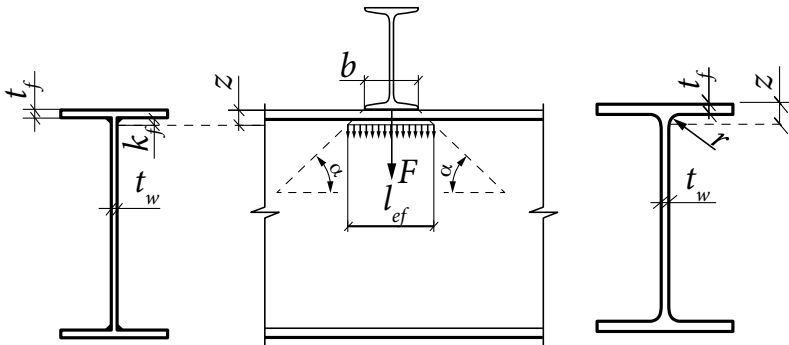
Схема действия местных напряжений в стенке балки: а) для сварного сечения; б) для прокатного сечения
